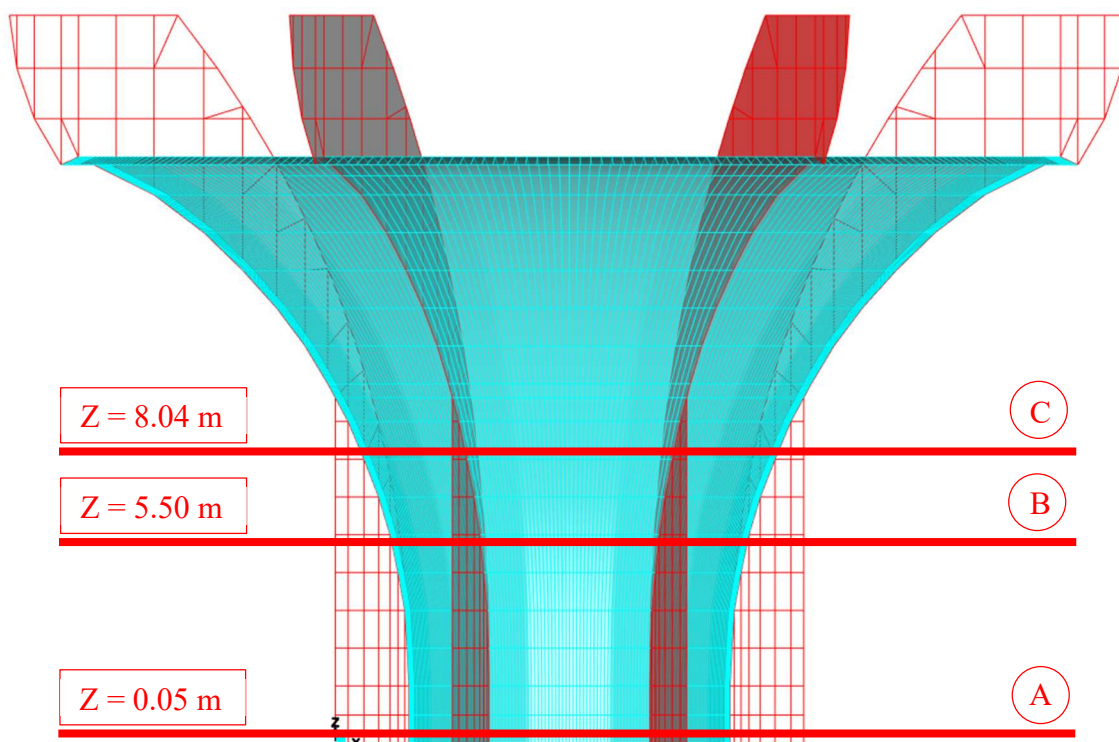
Posizione in altezza (asse Z) delle “section cut” delle sezioni a T
